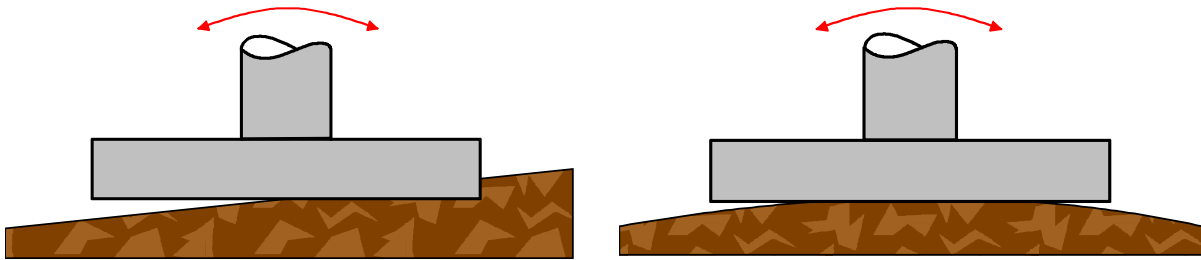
Fundamentbewegung gegenüber dem Baugrund
